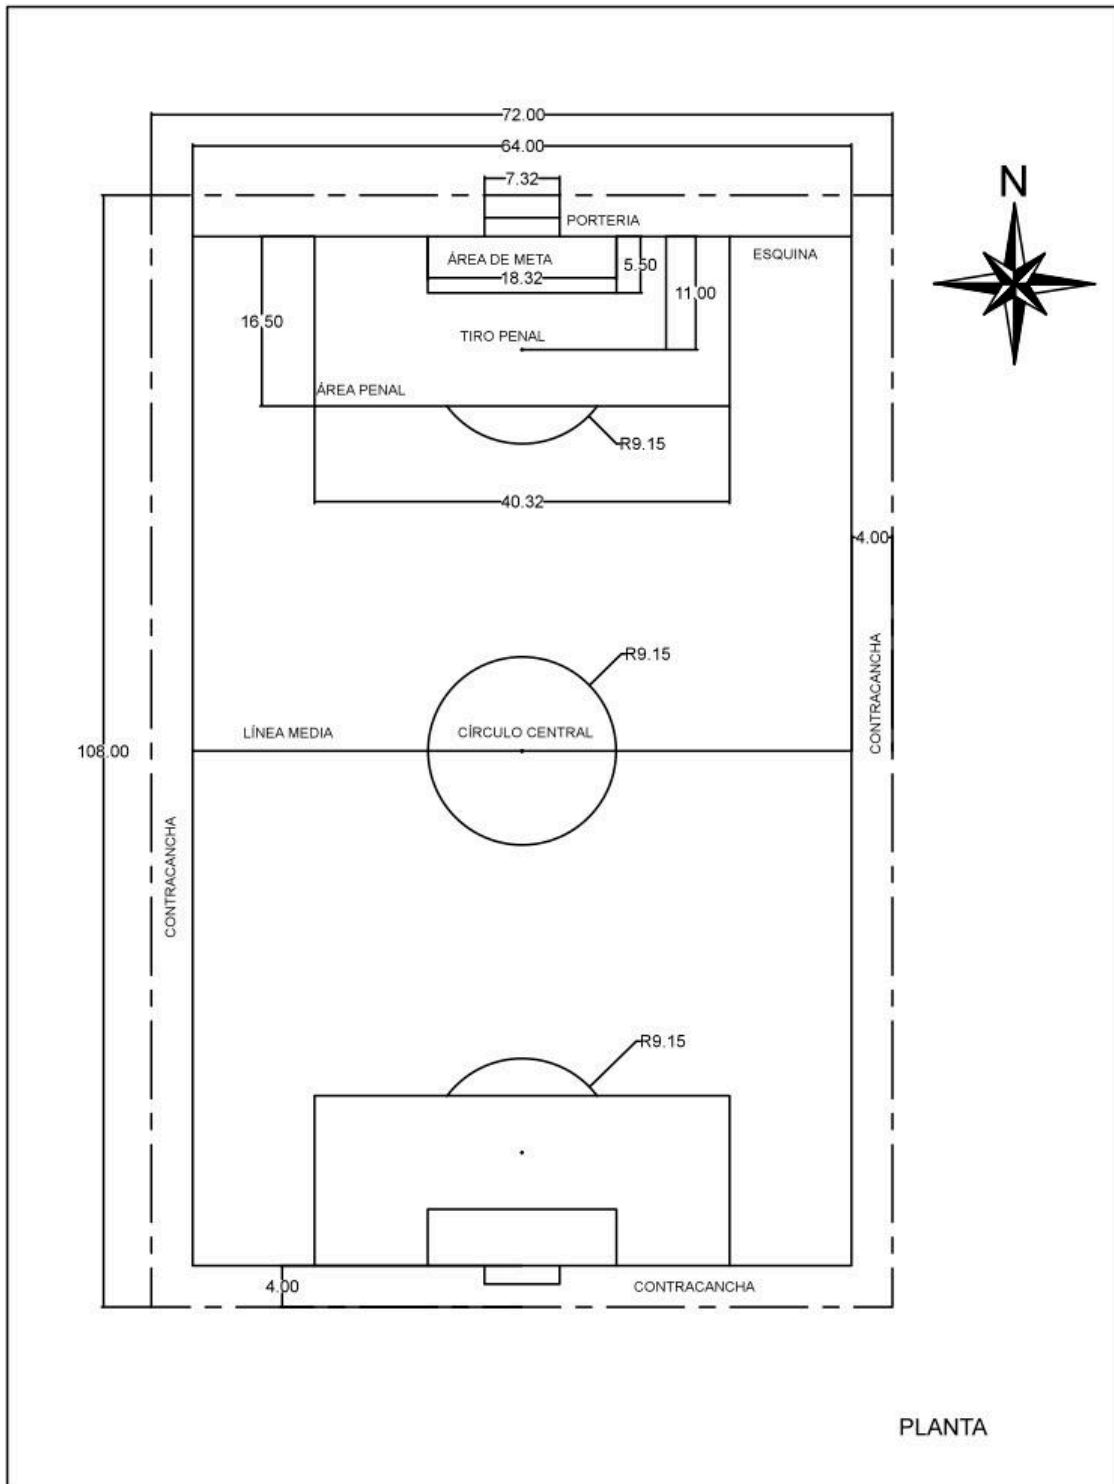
Planta de una cancha de fútbol soccer. Fuente: Elaboración propia
